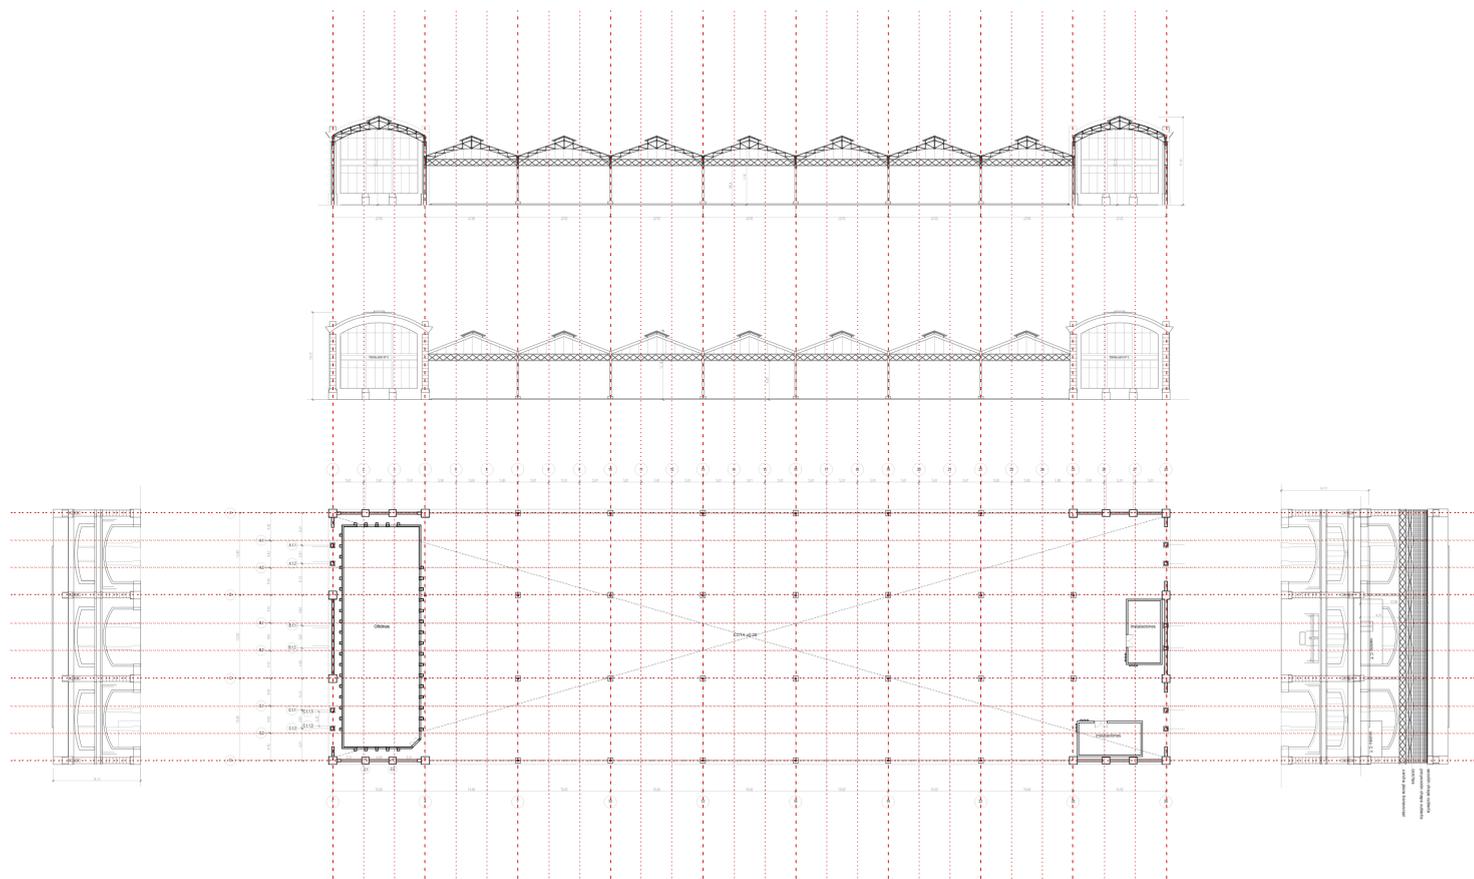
| En la parte de arriba se encuentra el alzado y la sección longitudinal y en la parte de abajo la planta y los alzados de las otras fachadas.
